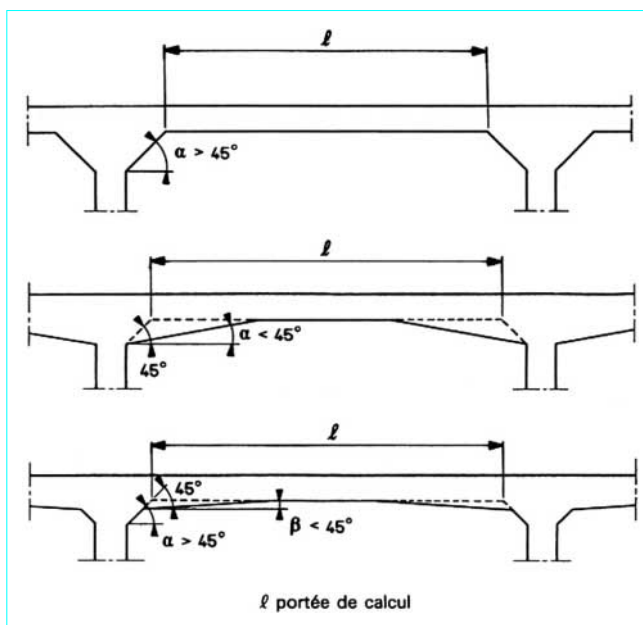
Dalles avec goussets. Portées à prendre en compte dans les calculs
